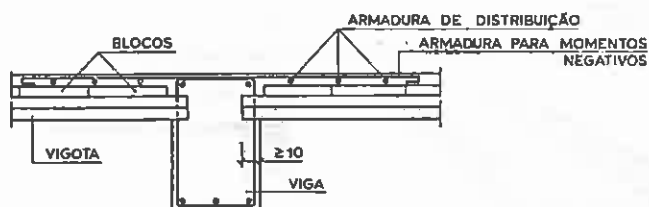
Vigotas pré-esforçadas: pormenor de apoio
